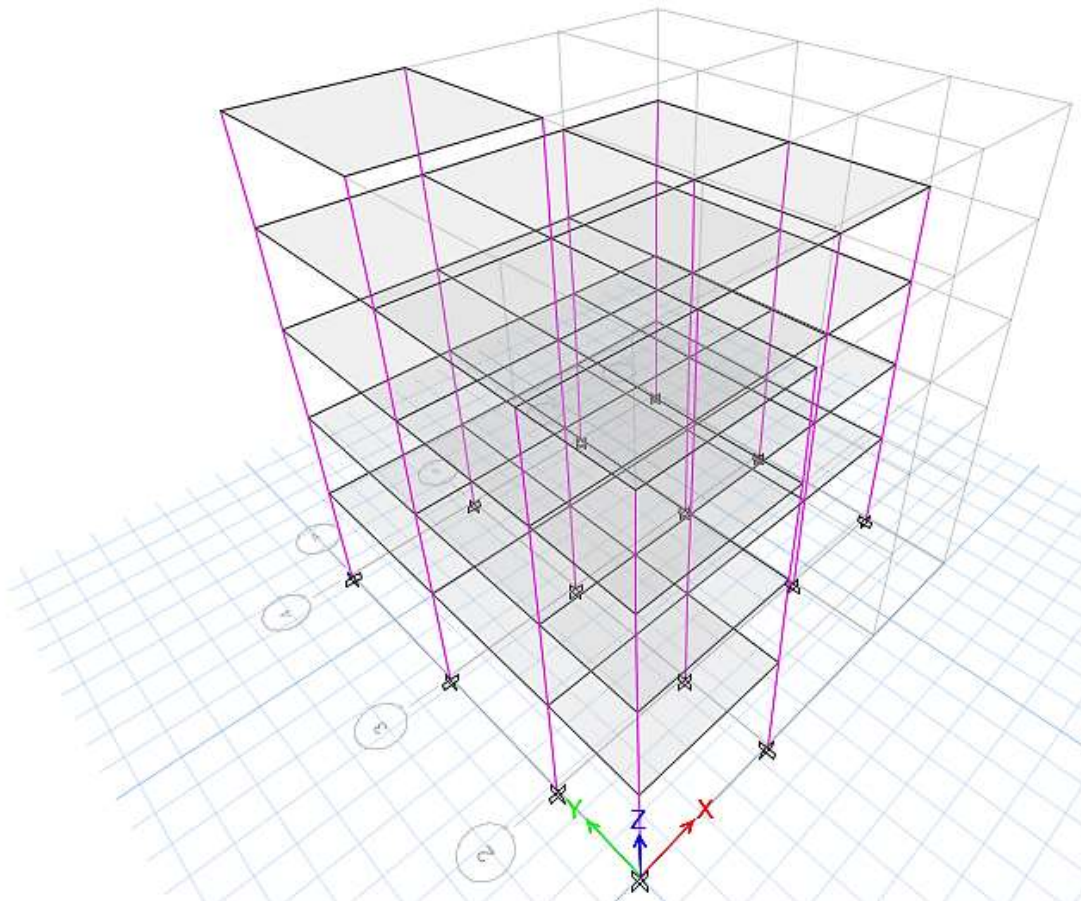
Modelo 3D de identificación de fallas en elementos de hormigón
